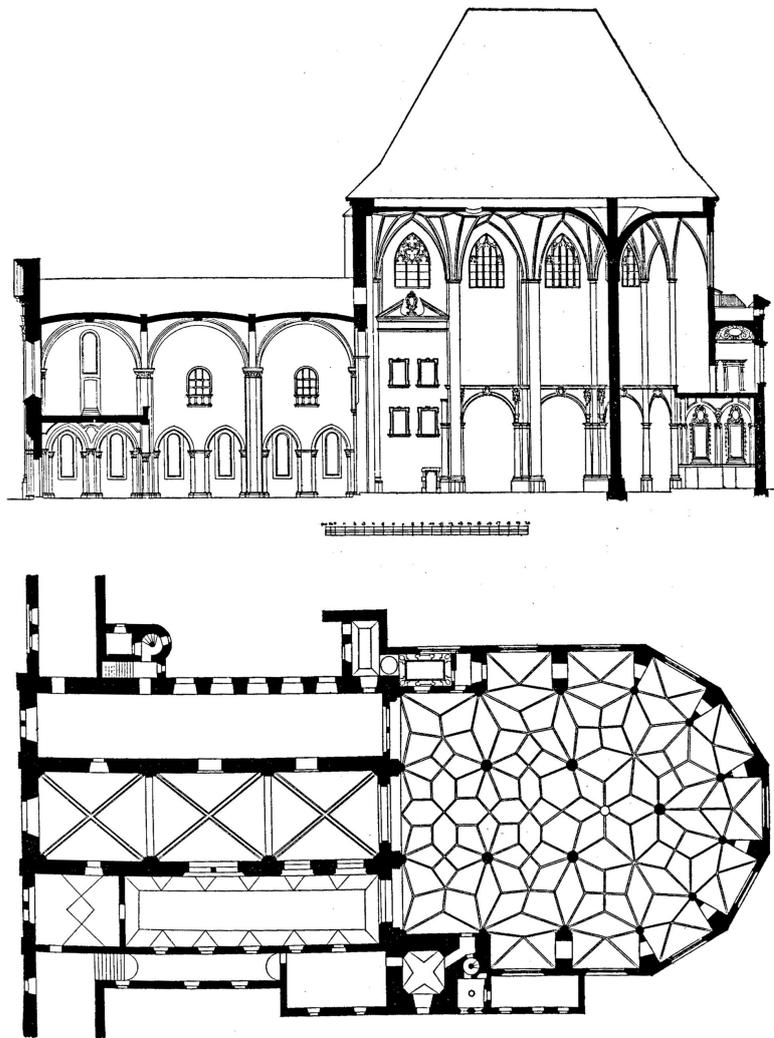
Salzburg, Franziskanerkirche. Grundriss und Längsschnitt. Bild: Nussbaum 1984, S. 109.
